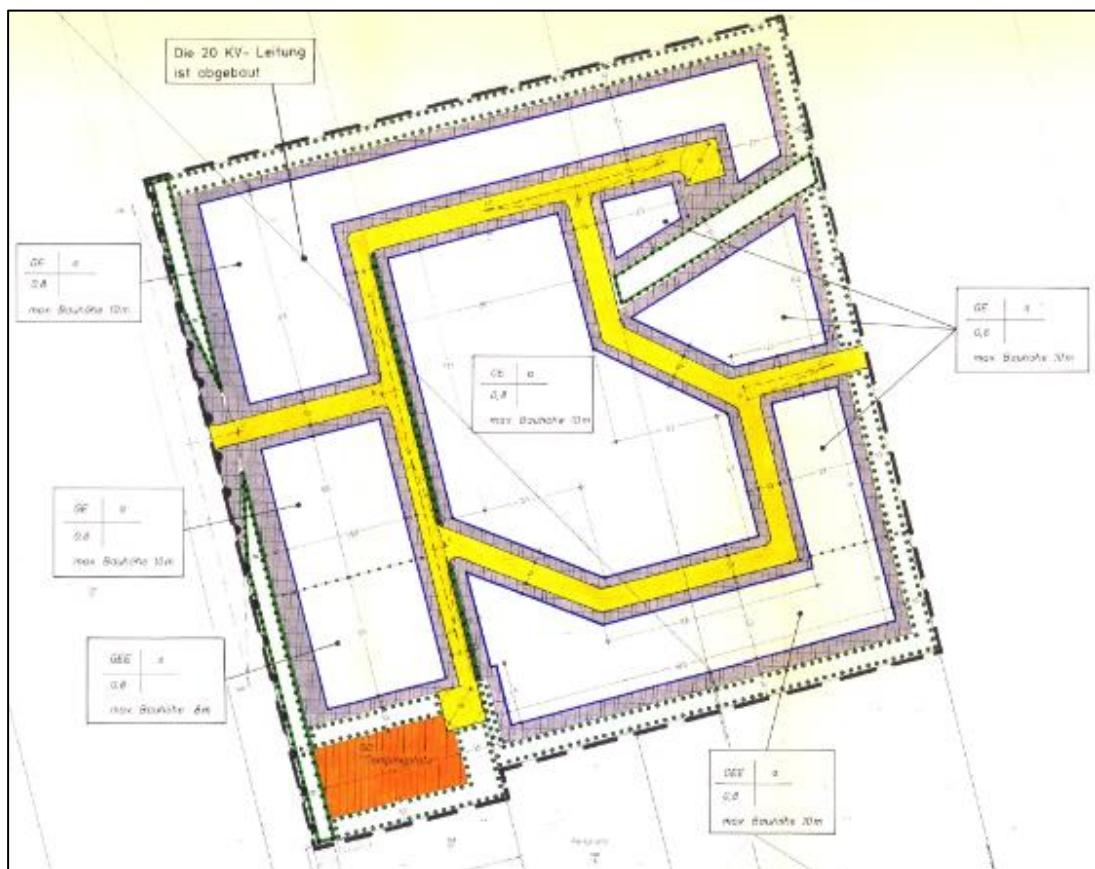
Ursprungsbebauungsplan Nr. 28 „Kirchdamm / Seehausen“
